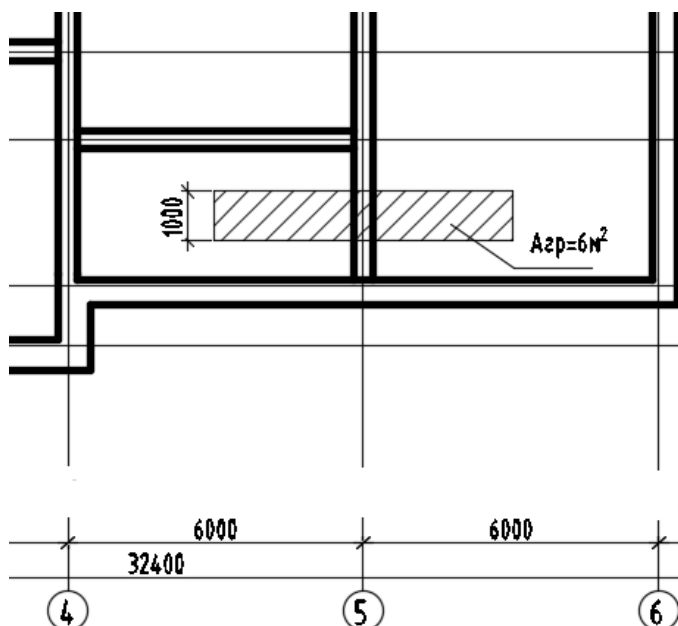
Грузовая площадь наиболее нагруженной средней стены
